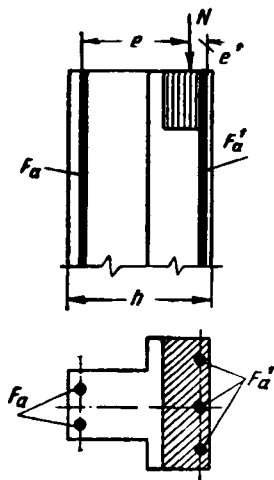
Внецентренное сжатие армированной кладки при больших эксцентриситетах
